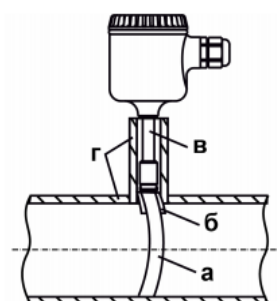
Монтаж датчика ДТС325М: а) хомут; б) пластина-теплообменник; в) арматура датчика; г) теплоизоляционный материал для трубопровода
